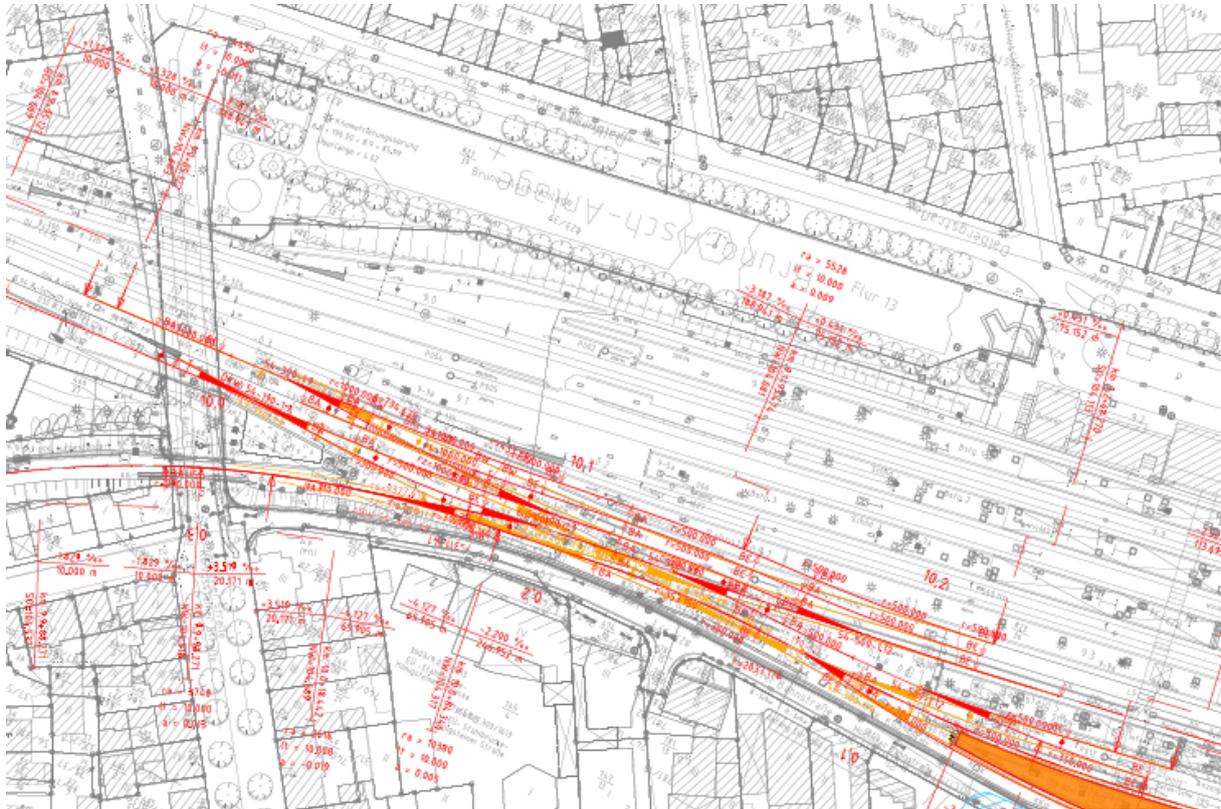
Ausschnitt Oberleitungsumbau Bf Höchst Strecke 3603 km 9,0+05 – 9,2+90 und Strecke 3640 km 10,0+37 – 10,1+60
